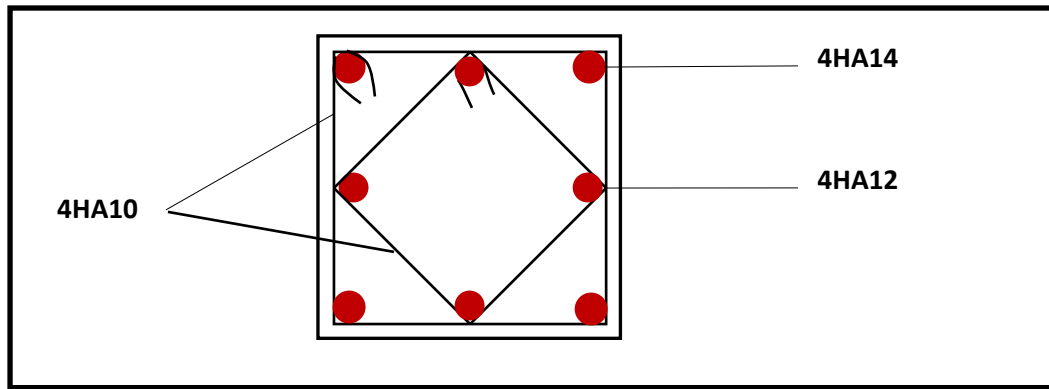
Schéma de ferrailage du poteau 35x35.
